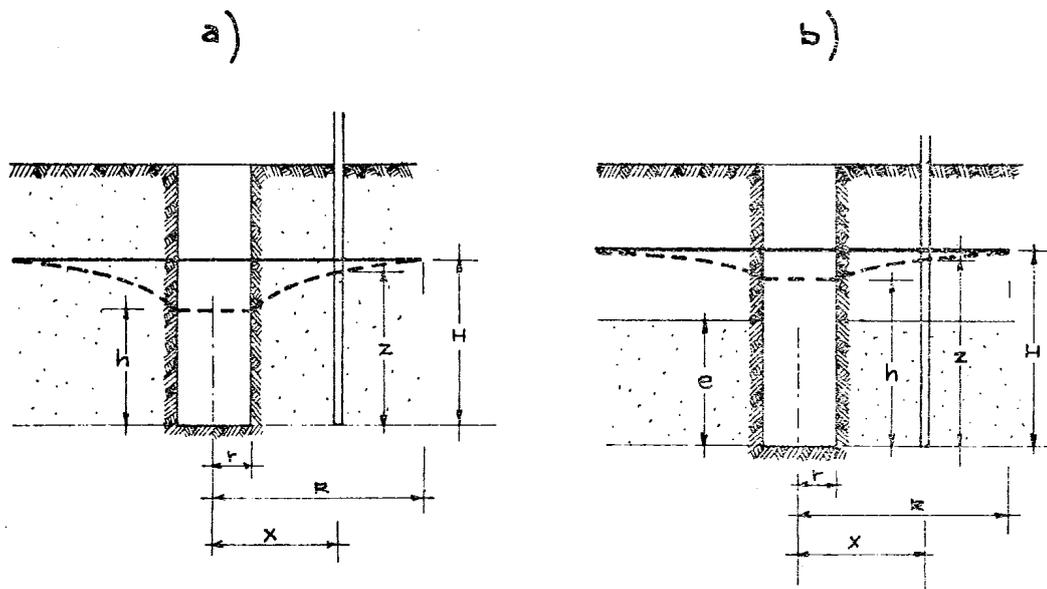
SCHEMA DI PROVE DI EMUNGIMENTO IN PERFORAZIONE DI SONDAGGI CON 1 PIEZOMETRO DI MISURA); a) FALDA A PELO LIBERO b) FALDA IN PRESSIONE.
